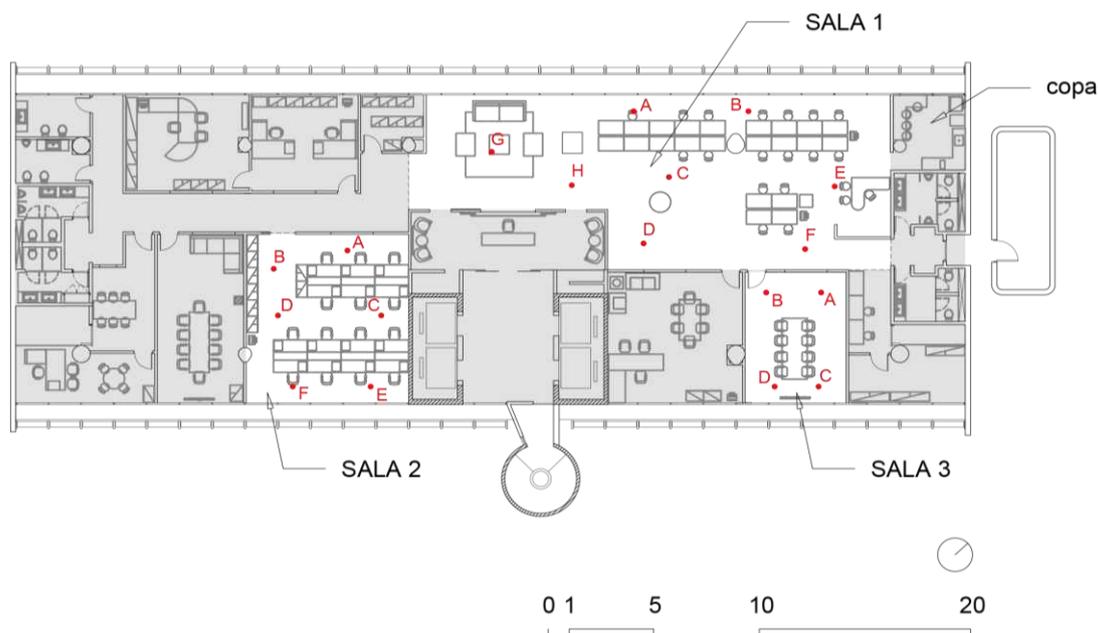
Layout do pavimento estudado do Edifício Banco Sul-Americano com os pontos de medição utilizados.
